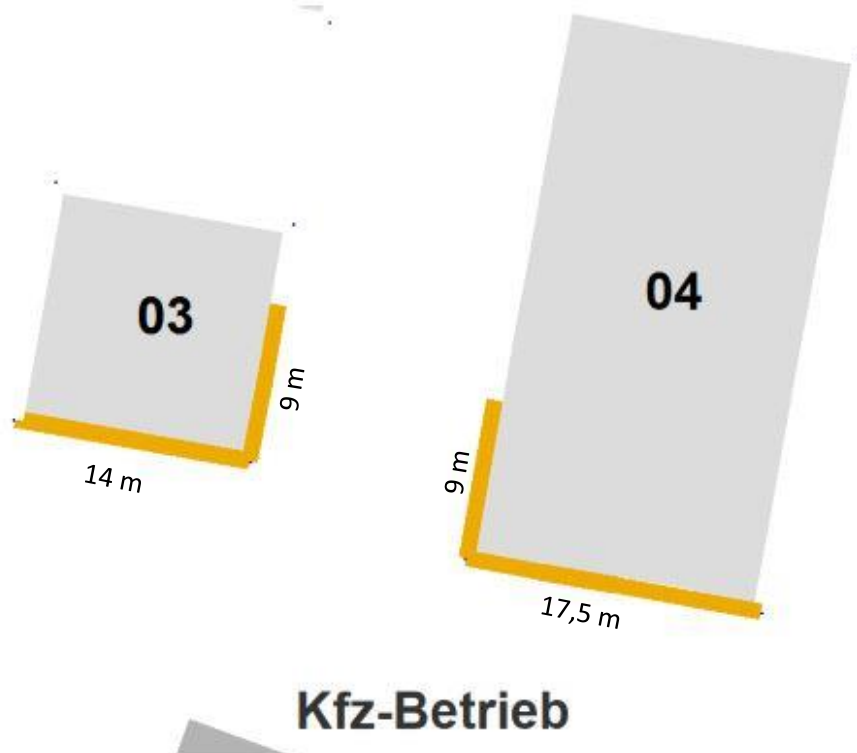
Fassadenabschnitte der Baufenster 03 und 04 mit Überschreitung von Spitzenpegeln an den orange markierten Bereichen
